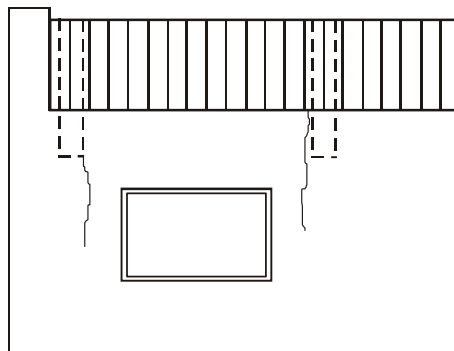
fissuras verticais em parede de alvenaria por dilatação de tesouras de madeira (DUARTE, 1998)
